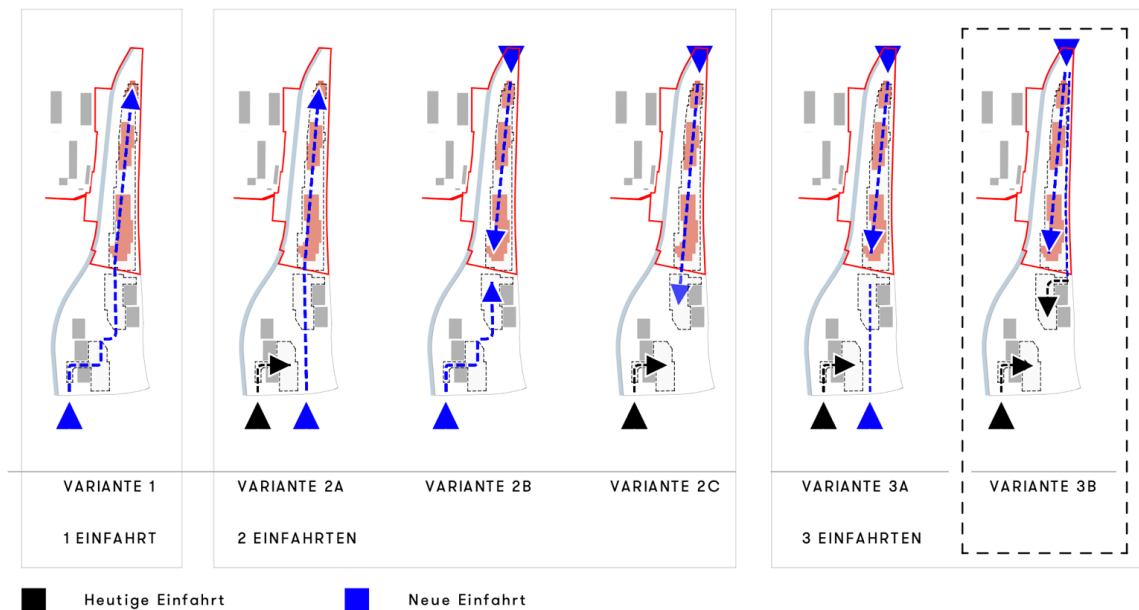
Schema Erschliessungsvarianten Autoeinstellhalle
